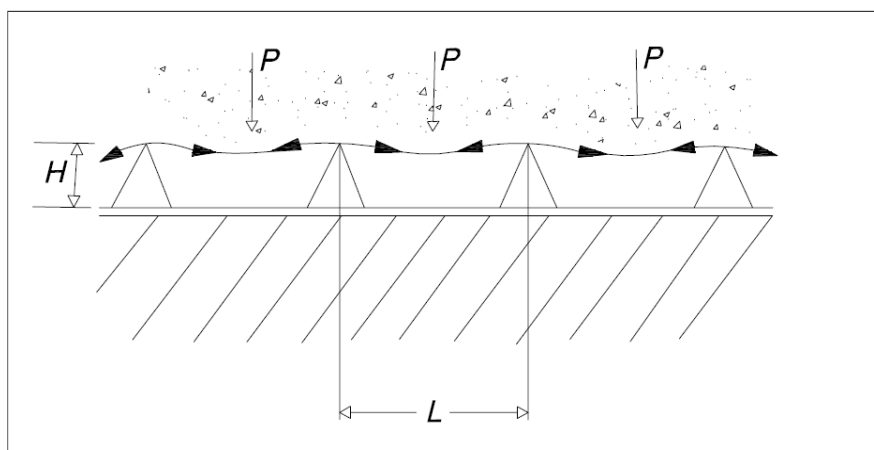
Diminuzione dell'area della sezione trasversale del geocomposito drenante a contatto con il terreno
